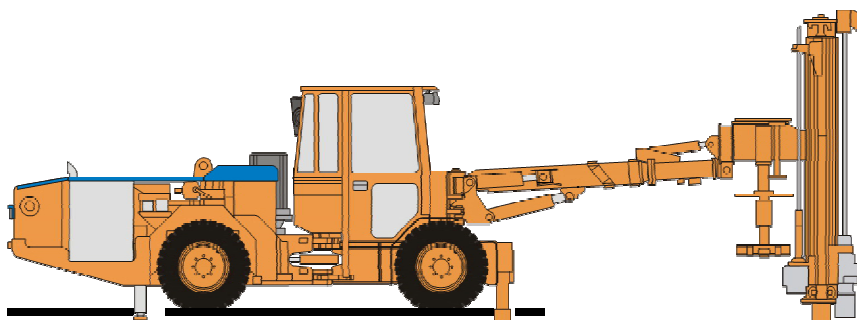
Общий вид установки для крепления анкерами Robolt 5-126 XL Cabin
